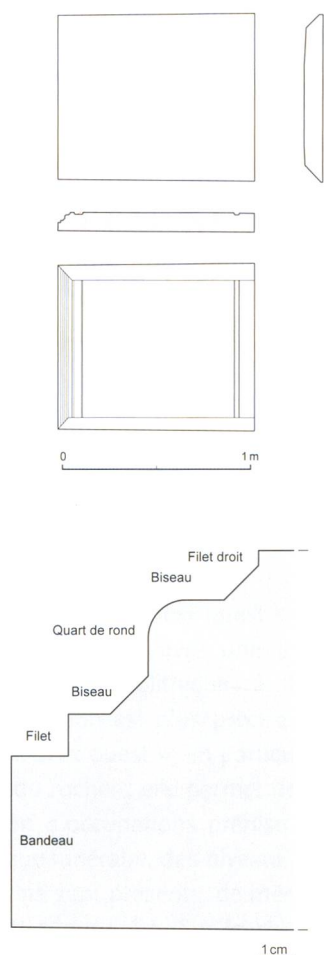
Présentation des faces et des profils principaux ainsi que du détail de la moulure du bloc architectural n°10. Ech. 1 : 40, détail de la moulure : éch. 1/2.
